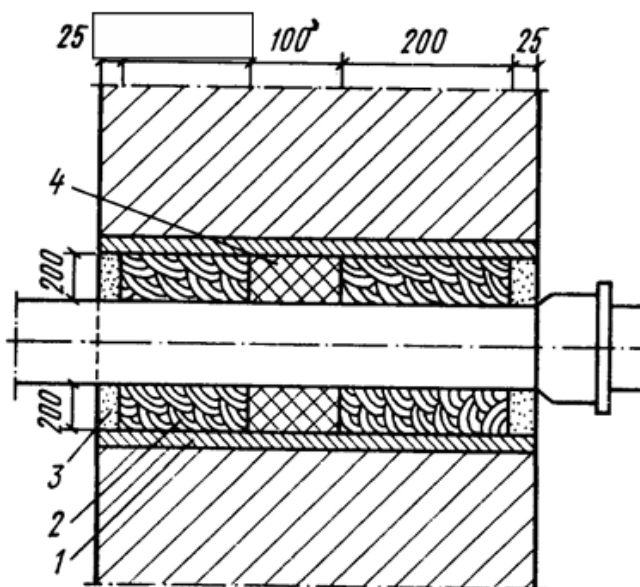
Введення водопроводу через стіну підвалу в сухих ґрунтах
